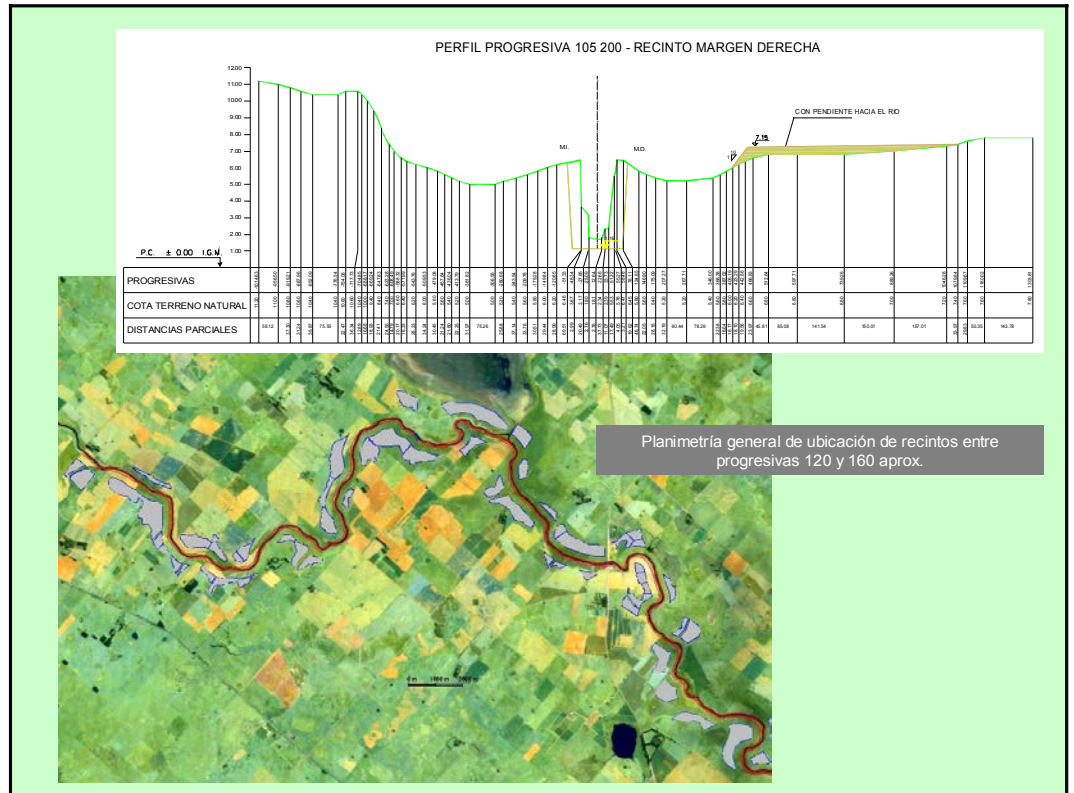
Planialtimetría tipo para las obras del río Salado
